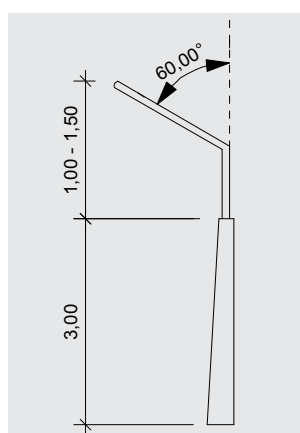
Mur d'entraînement avec grillage – dimensions et forme
